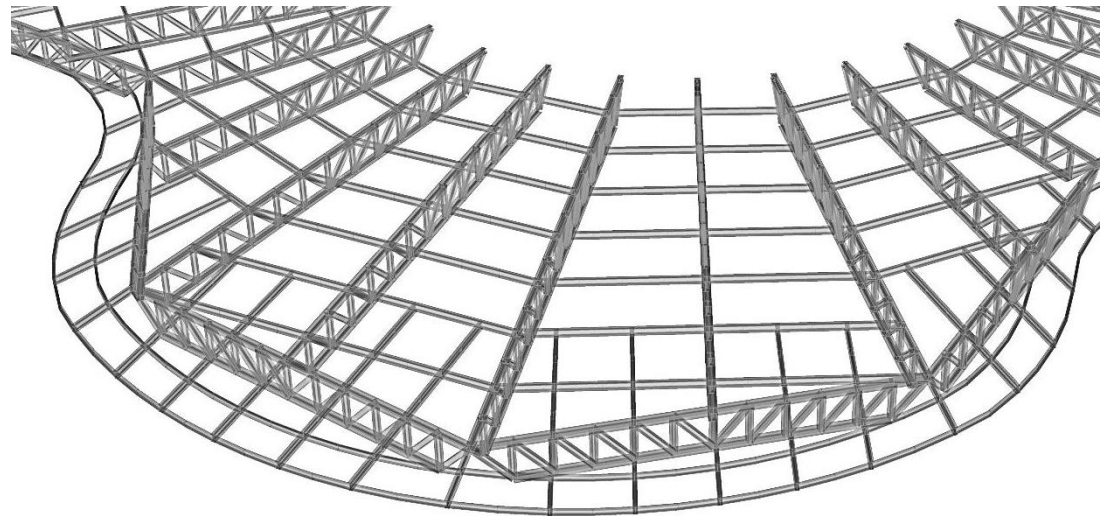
Detalle del modelo 3D estructural del forjado sin losa de la planta tipo 1
